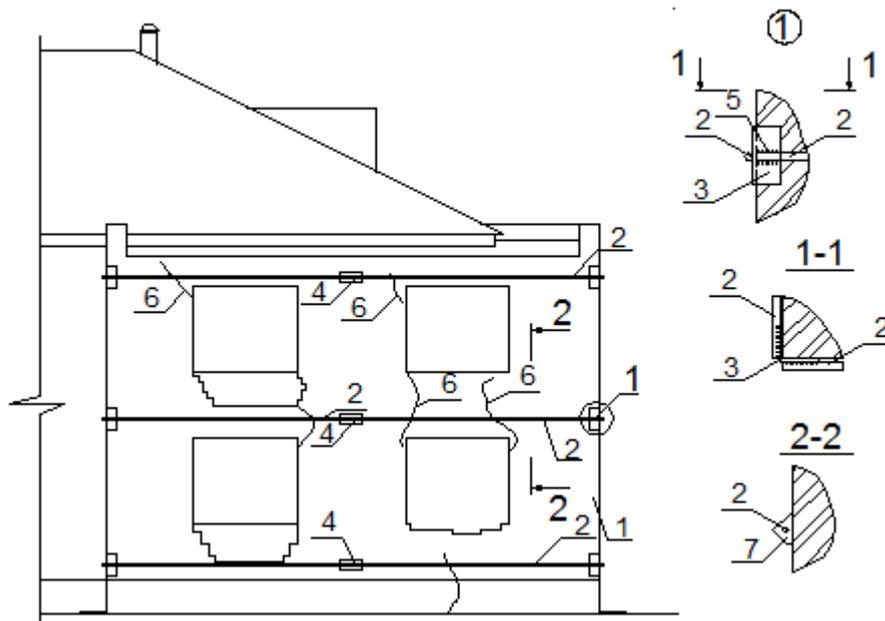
усиление напряженными поясами: 1 – усиливаемая стена; 2 – тяжи; 3 – стальные уголки 150*150 мм; 4 – стяжные муфты; 5 – сварной шов; 6 – трещины; 7 – промежуточный карниз из цементно-песчаного раствора
